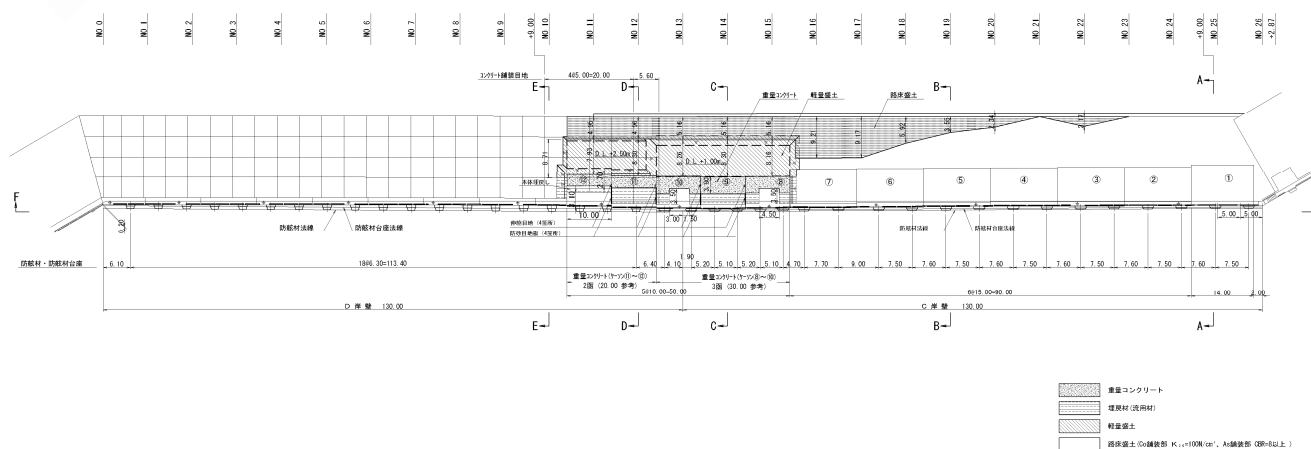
No.3 南公共ふ頭C岸壁(-7.5m)平面図(復旧後)
